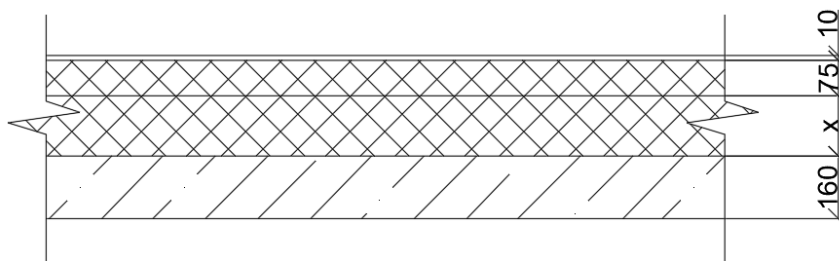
Схема ограждающей конструкции чердачного перекрытия
